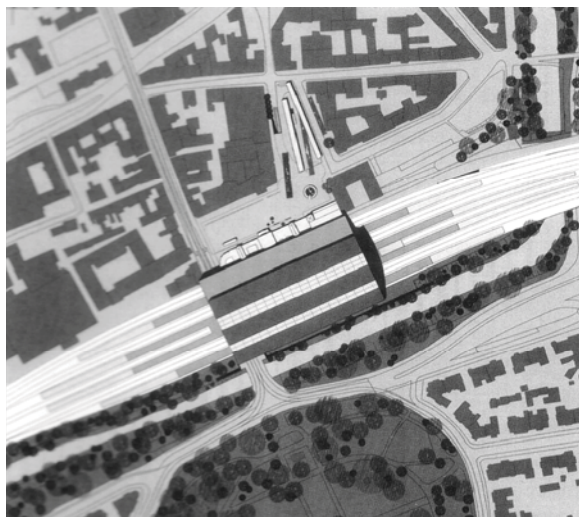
Lageplan des neuen Erfurter Hauptbahnhofes
